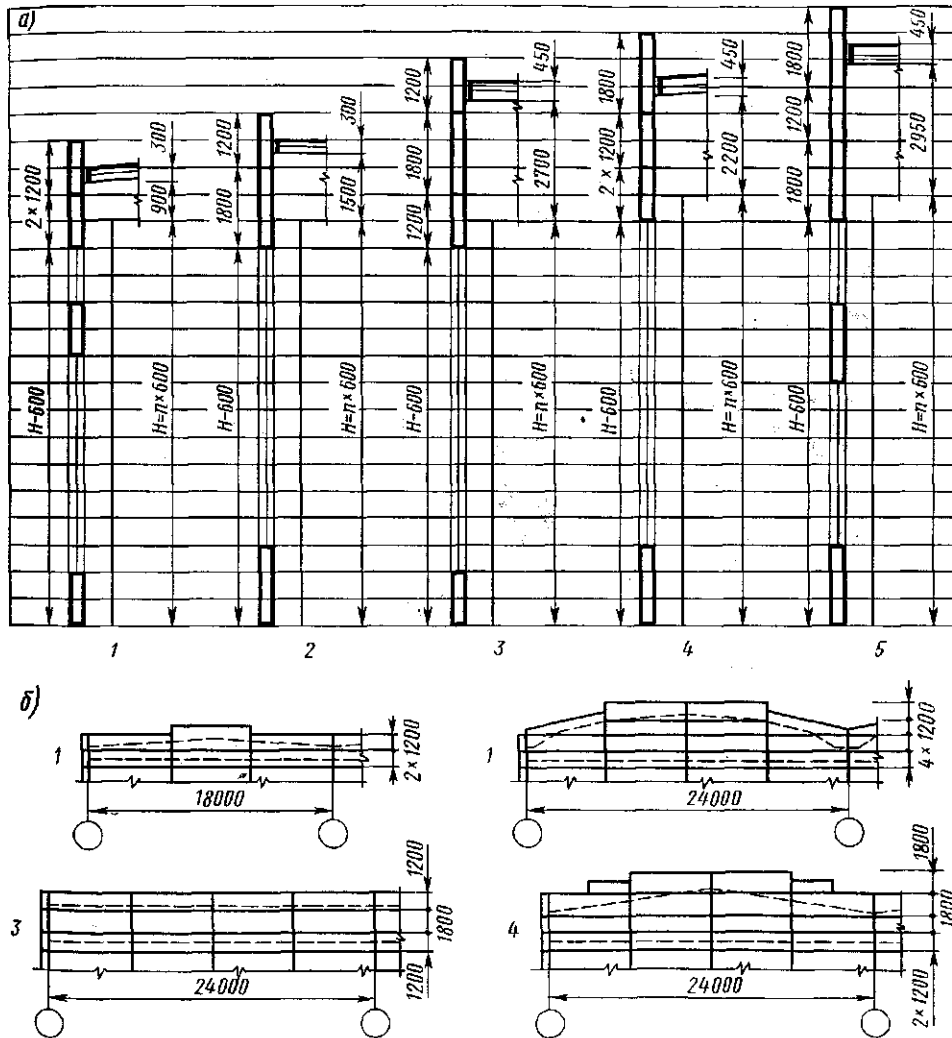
Схемы раскладки панелей в стенах одноэтажных зданий:
